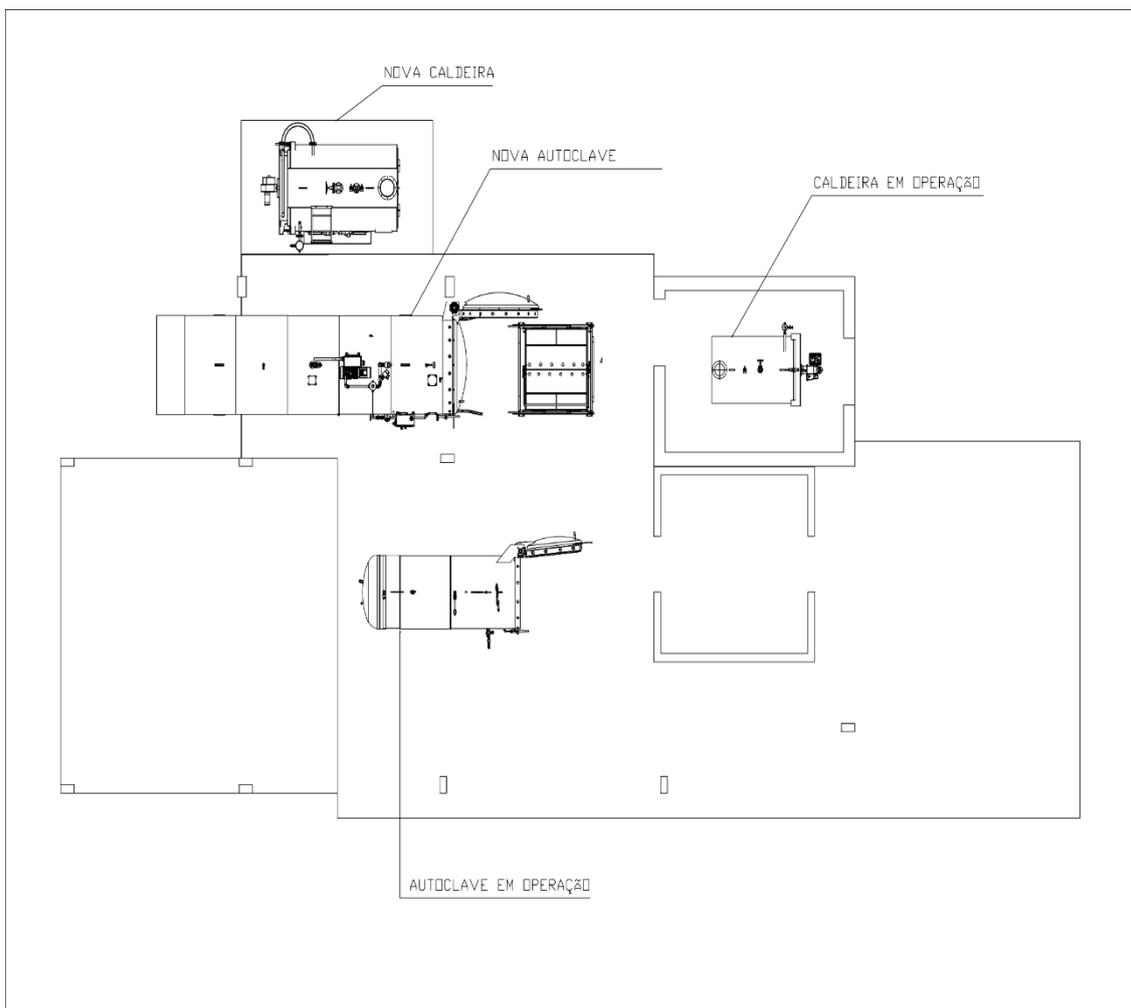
DIMENSÕES CALDEIRA/AUTOCLAVE EM OPERAÇÃO E O FUTURO CONJUNTO A SER INSTALADO
